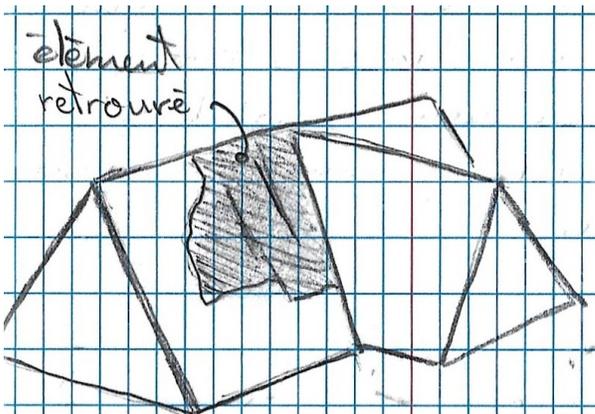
Forme présumée de la toiture avec l'annexe à droite
